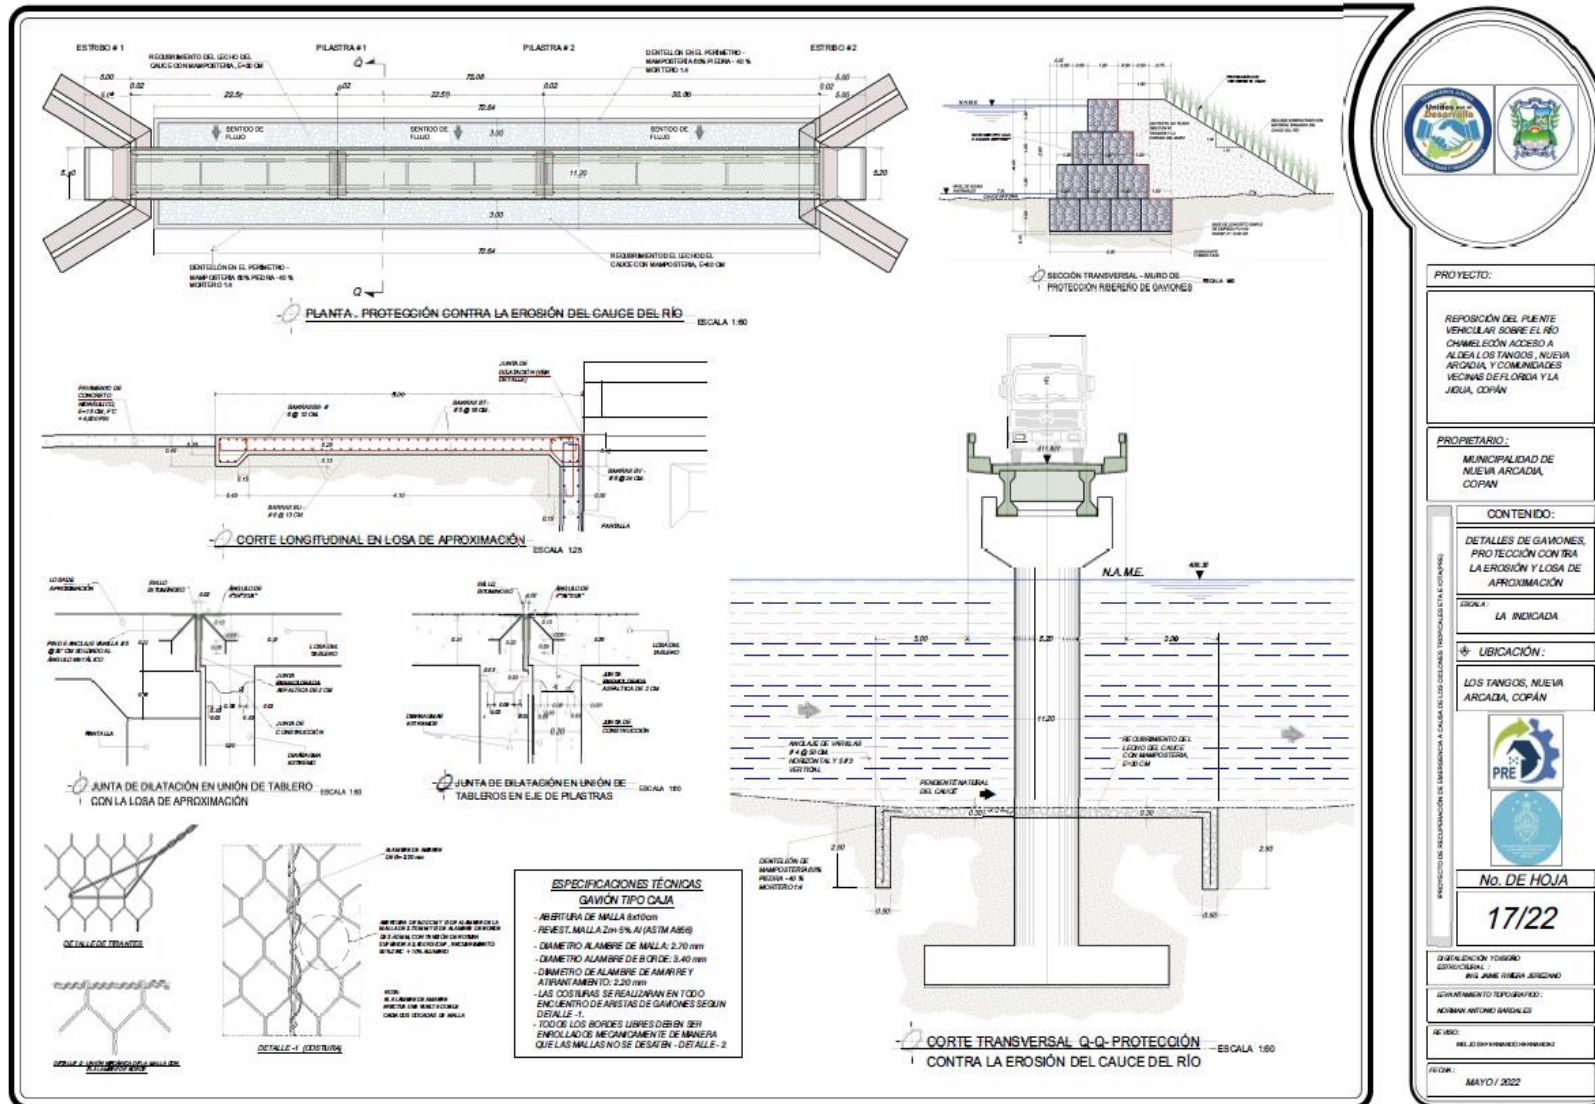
Plano detalle de gaviones y protección contra la erosión
